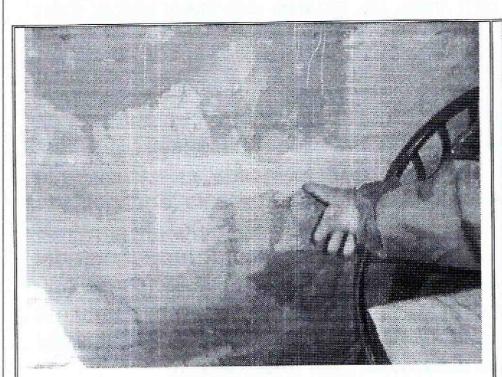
Fisuras sobre el muro de cerramiento sobre el costado norte de la vivienda.
